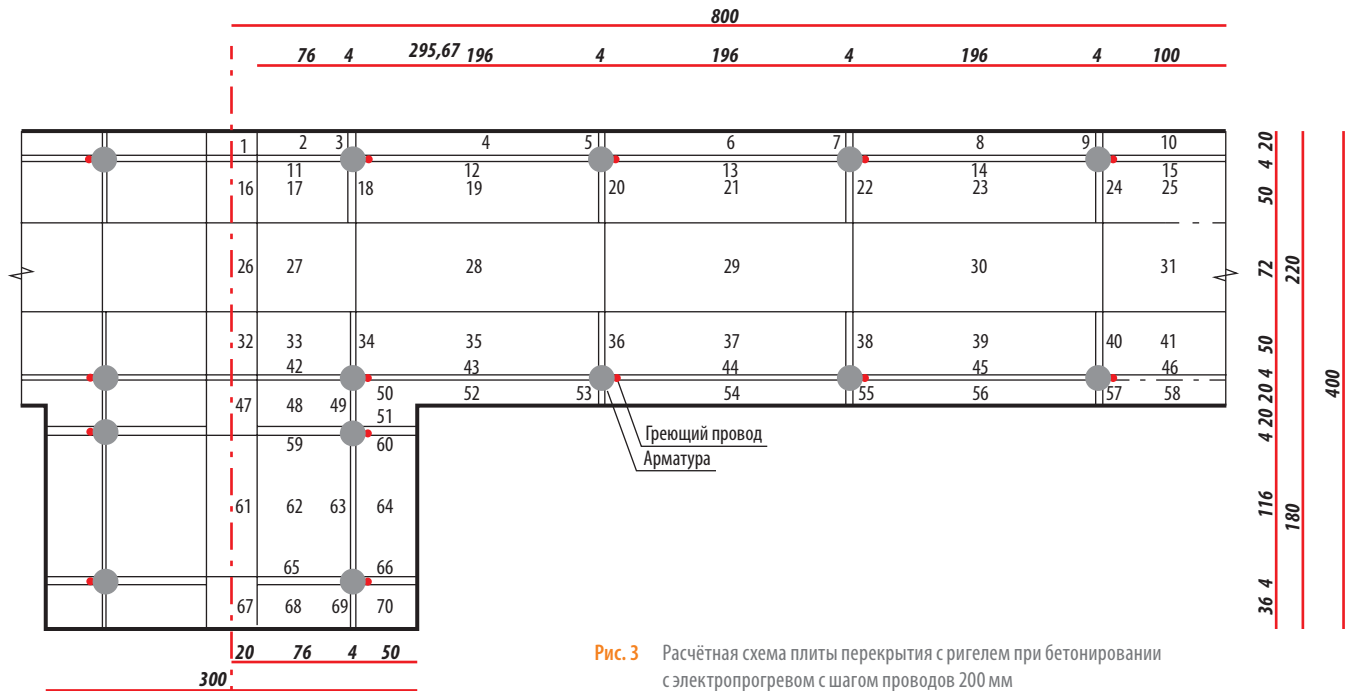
Расчётная схема плиты перекрытия с ригелем при бетонировании с электропрогревом с шагом проводов 200 мм
